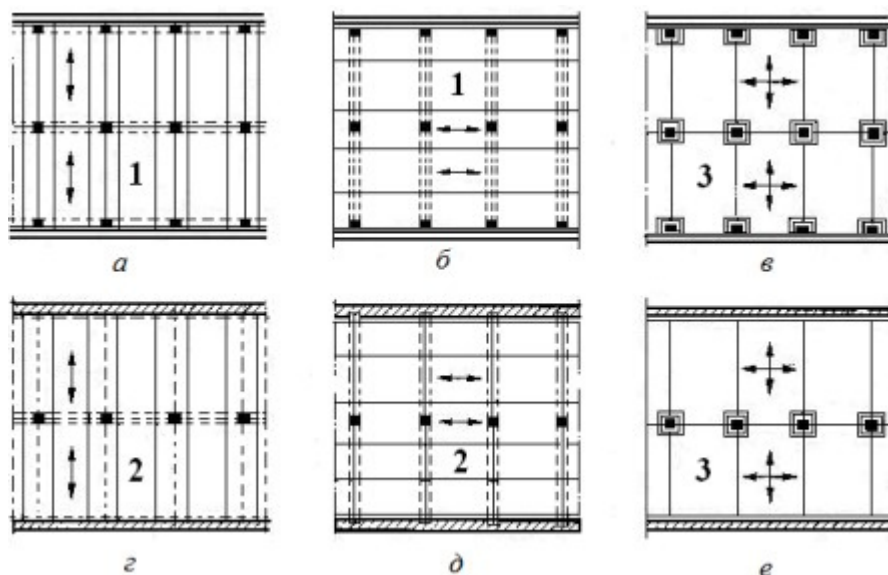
Конструктивные схемы зданий на плане фундаментов.
